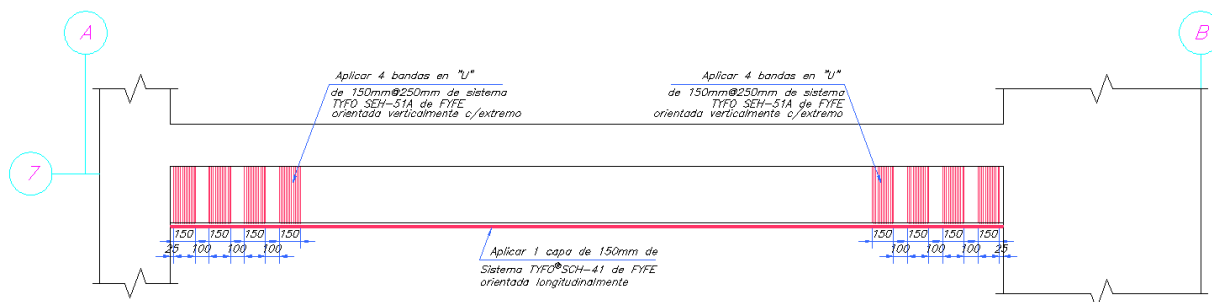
Ejemplo de Anclaje en extremos mediante sujeciones en U de FRP en Viga de Concreto armado externamente reforzada con FRP. (Cortesía: Top Consult Ingeniería SAC).
